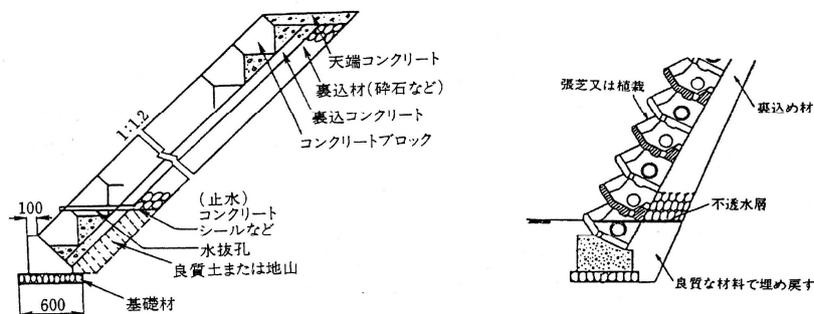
コンクリートブロック張工の例・緑化ブロックの例
